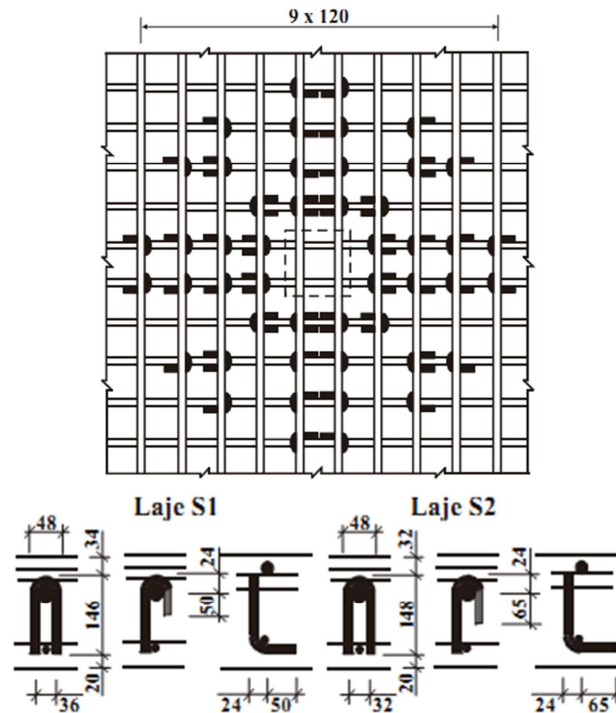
Detalhe da armadura de cisalhamento utilizada nas lajes S1 e S2 (Regan & Samadian, 2001)
